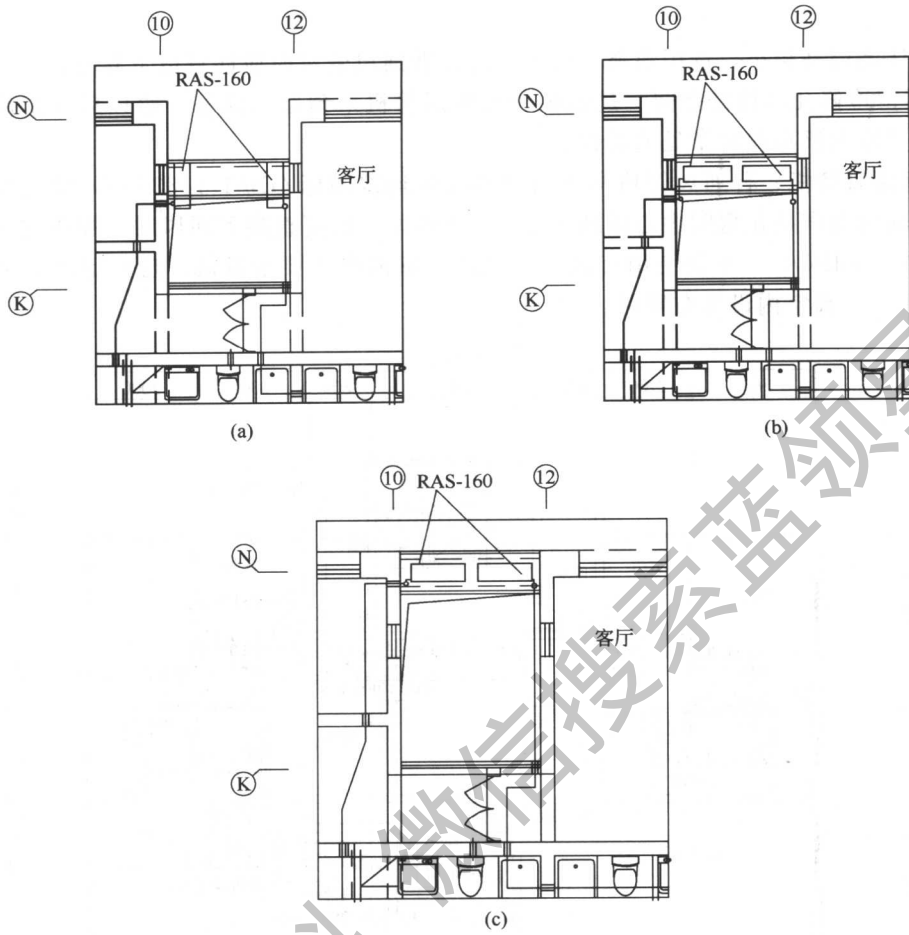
南京某高层住宅家用中央空调室外机的布置平面图
